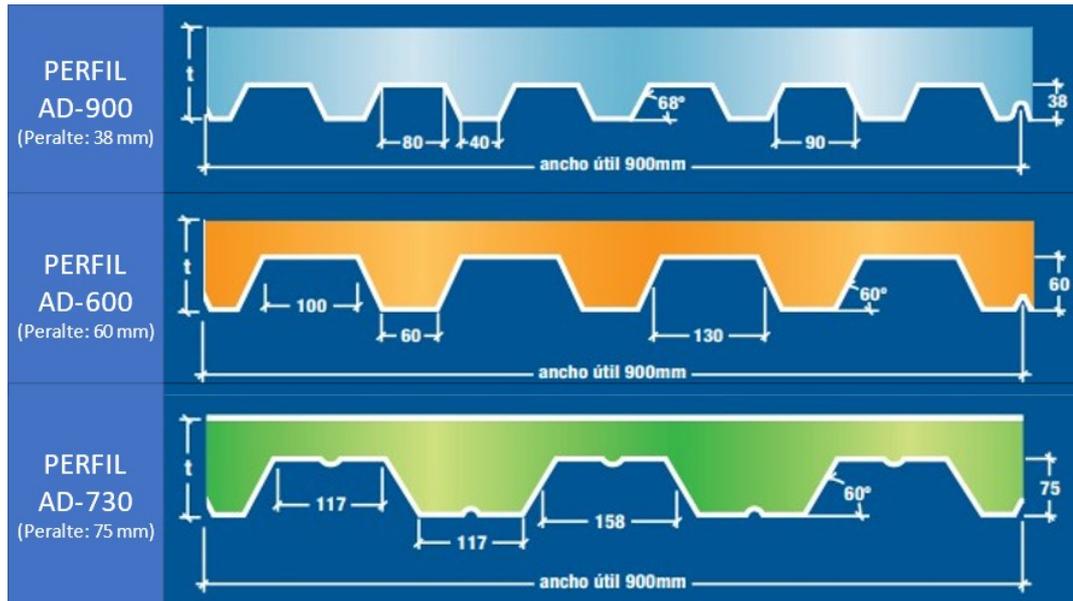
Sección de tipos de perfiles de placa colaborante.
